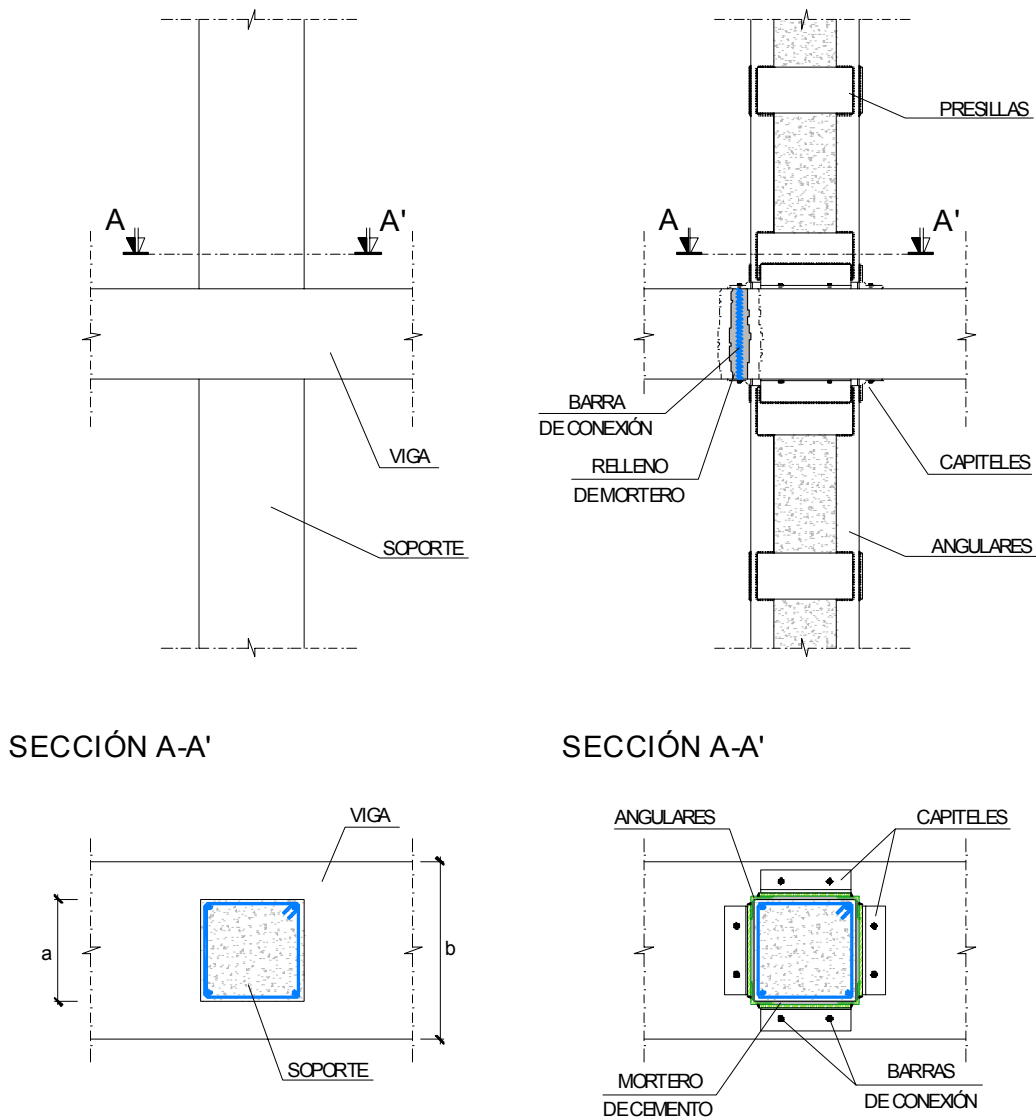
Conexión entre tramos de soporte de diferente planta. Viga de mayor anchura que el soporte ($b > a$)
